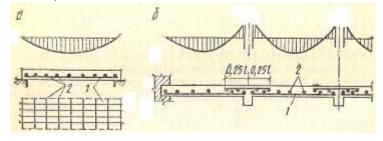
Однопролетная (а) и многопролетная (б) плиты при действии равномерно распределенной нагрузки:1 - стержни рабочей арматуры; 2 - стержни распределительной арматуры.
